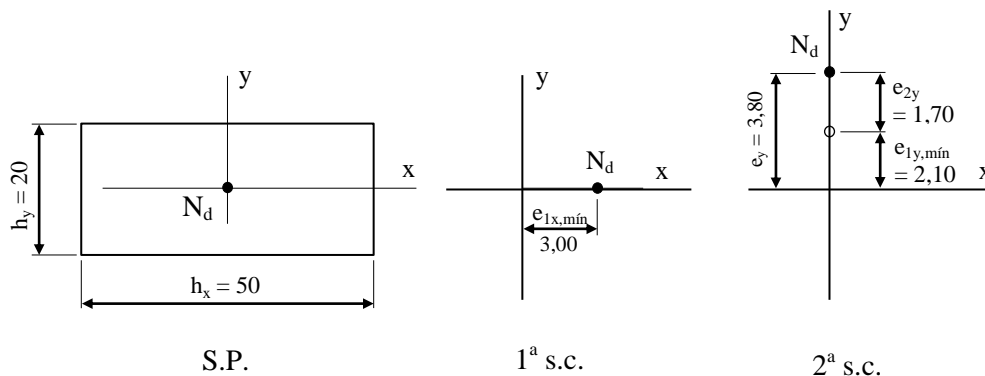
Situação de projeto e situações de cálculo do pilar intermediário.
